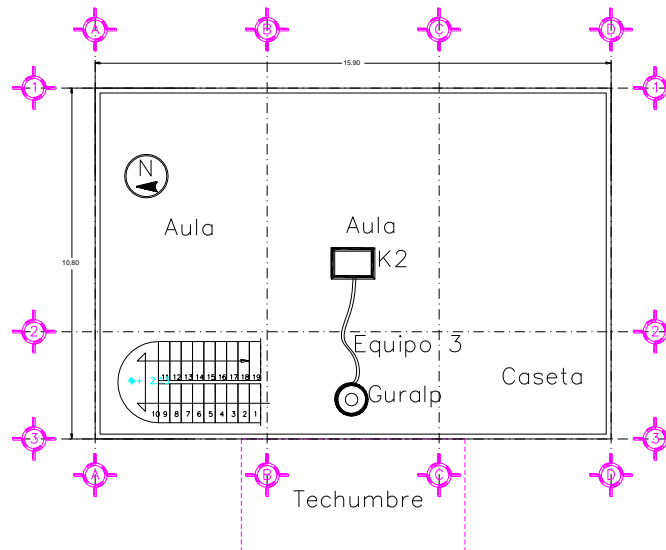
Imagen de distribución de equipos en planta baja de edificio ING7
